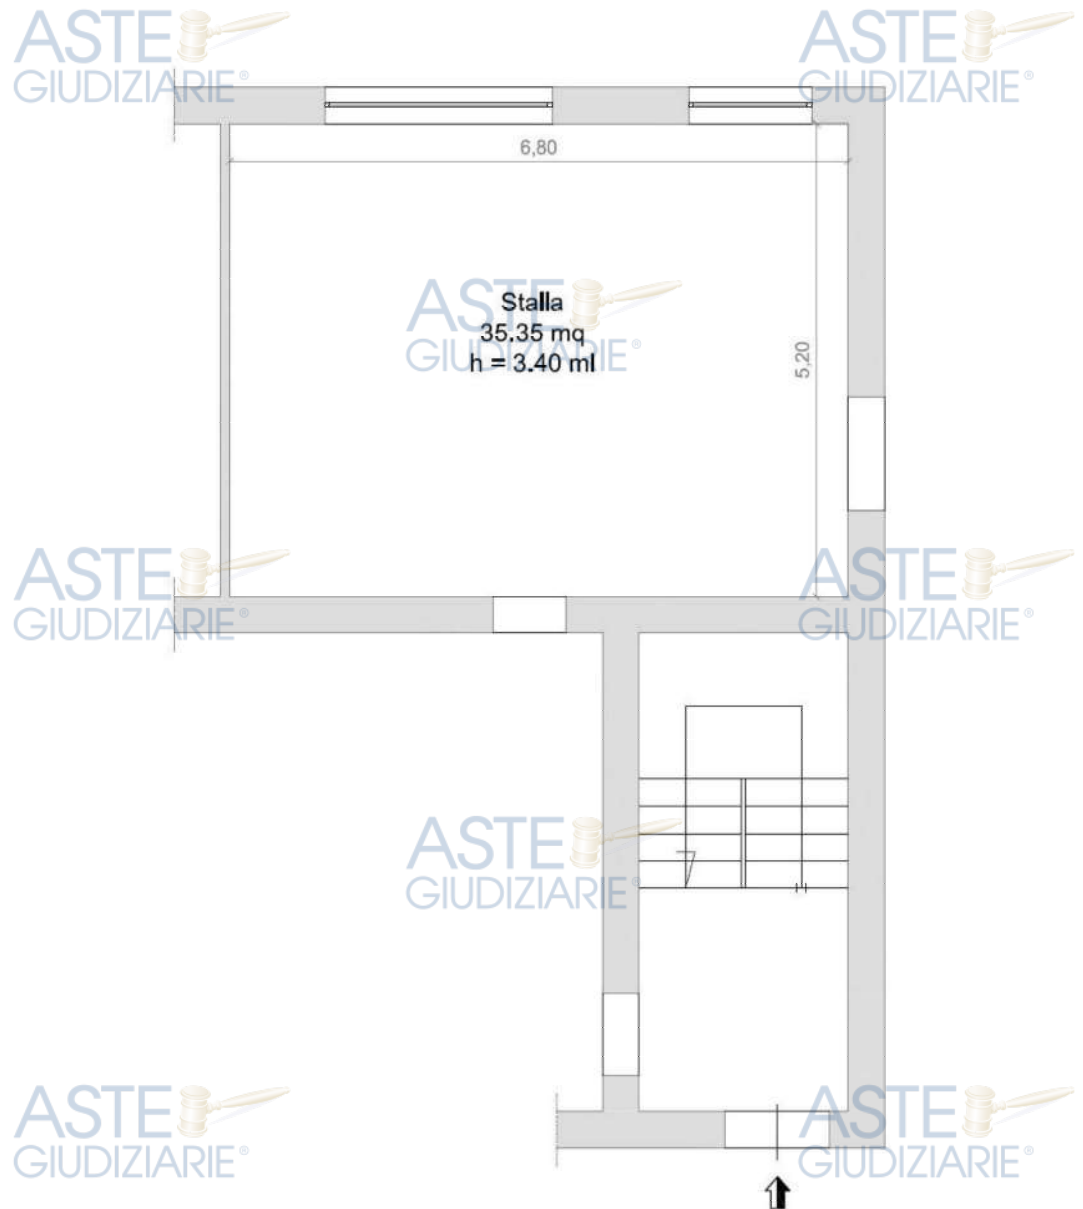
Planimetria Stato di Fatto Deposito Piano Terra, P.Ila 402, Sub 3.
